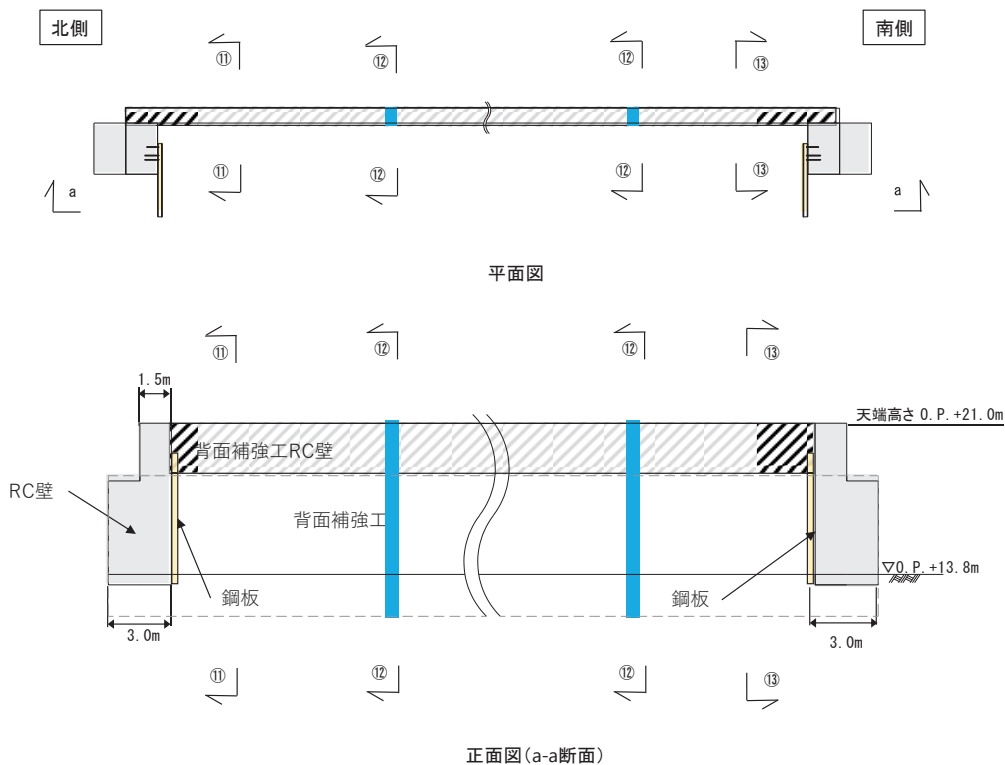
(1) 止水パターン⑪, ⑫, ⑬の構造概要(平面図, 正面図)
